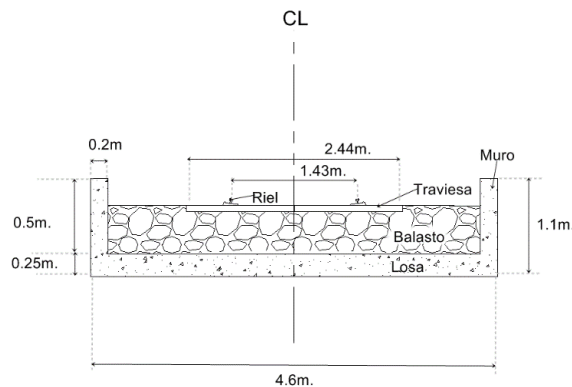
Sección típica del puente ferroviario, para un solo tren. Fuente: los autores
